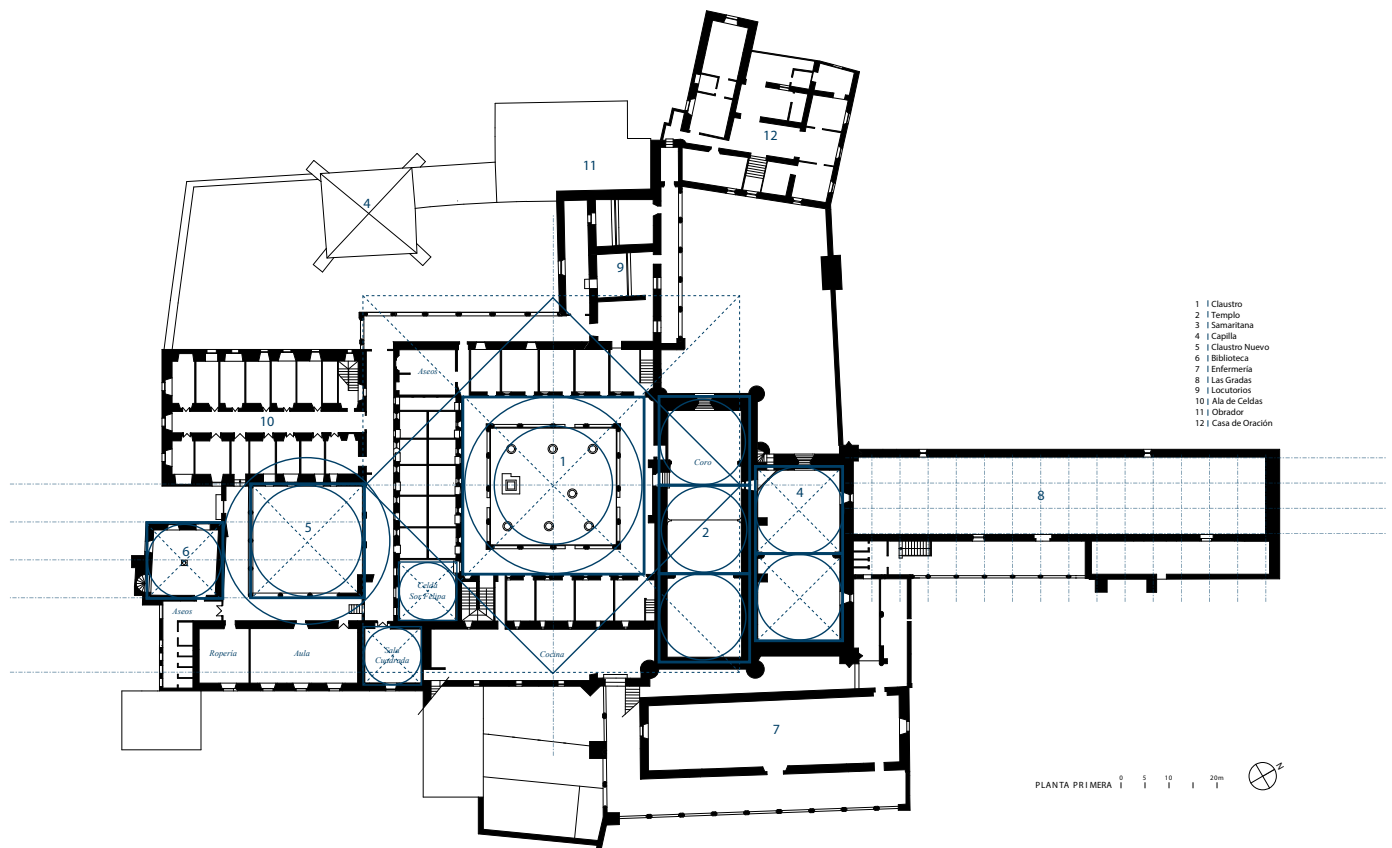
| Estudio y análisis de la planimetría (Elaboración propia sobre planimetría del estudio Pablo M. Millán Millán)
